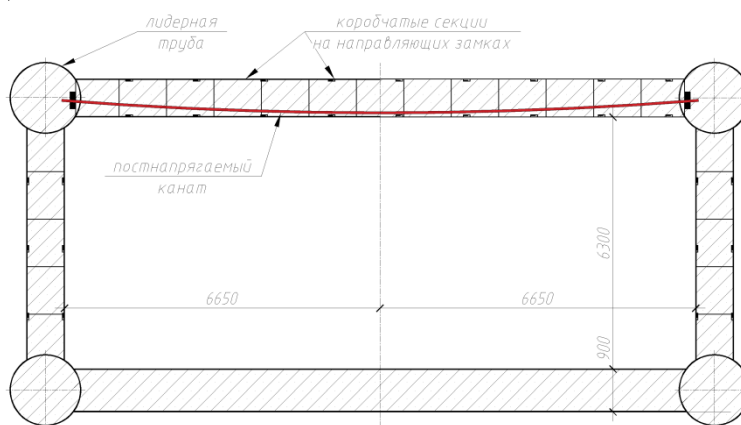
Поперечное сечение плитного опережающего перекрытия с постнапряжением, устраиваемым из лидерных труб.
